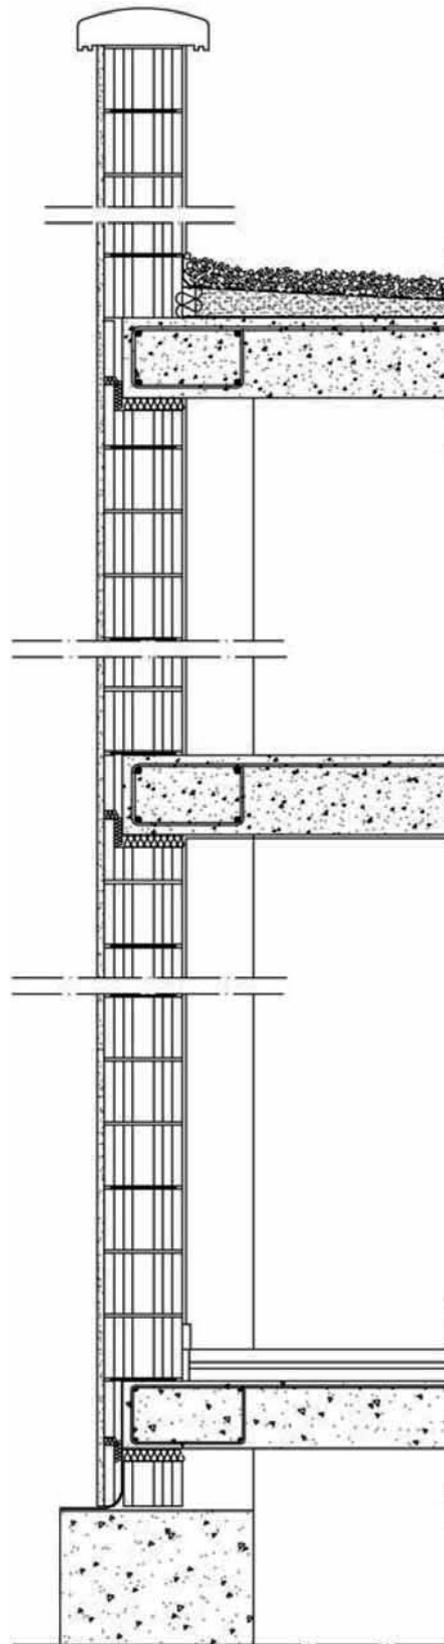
Sección de encuentro de muro de 1 hoja multicámara de cerramiento a niveles de planta baja, intermedia y cubierta.
